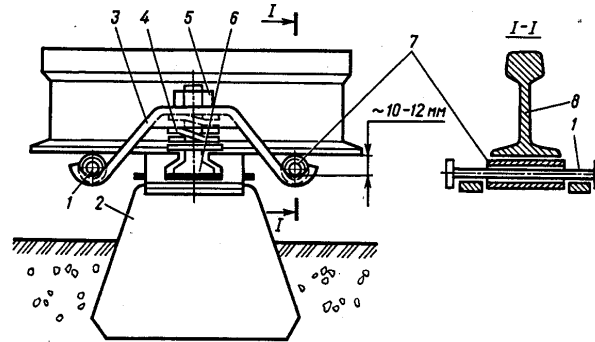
Підвісні ролики для розрядки напружень в рейкових плітях без припинення руху поїздів: 1 – вісь ролика; 2 – шпала; 3 – коромисло; 4 – шайба скріплення КБ; 5 – гайка; 6 – клемний болт; 7 – трубка; 8 – рейка
